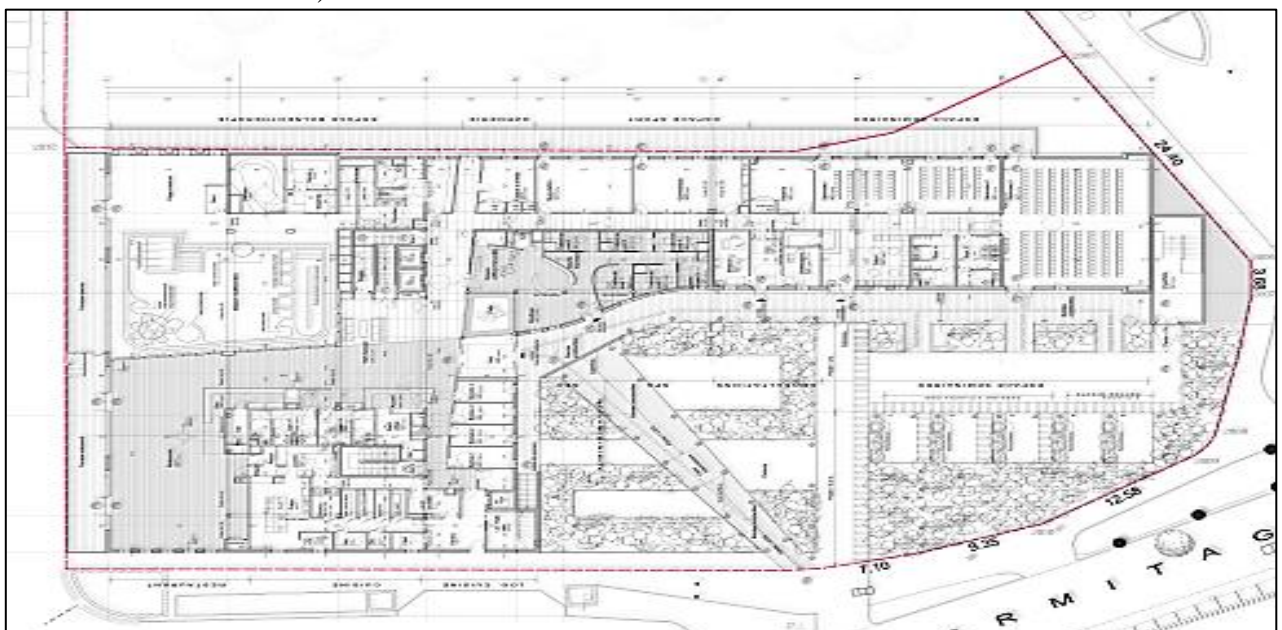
66: Plan du rez-de-chaussée du centre thalassothérapie Donville-les-Bains
